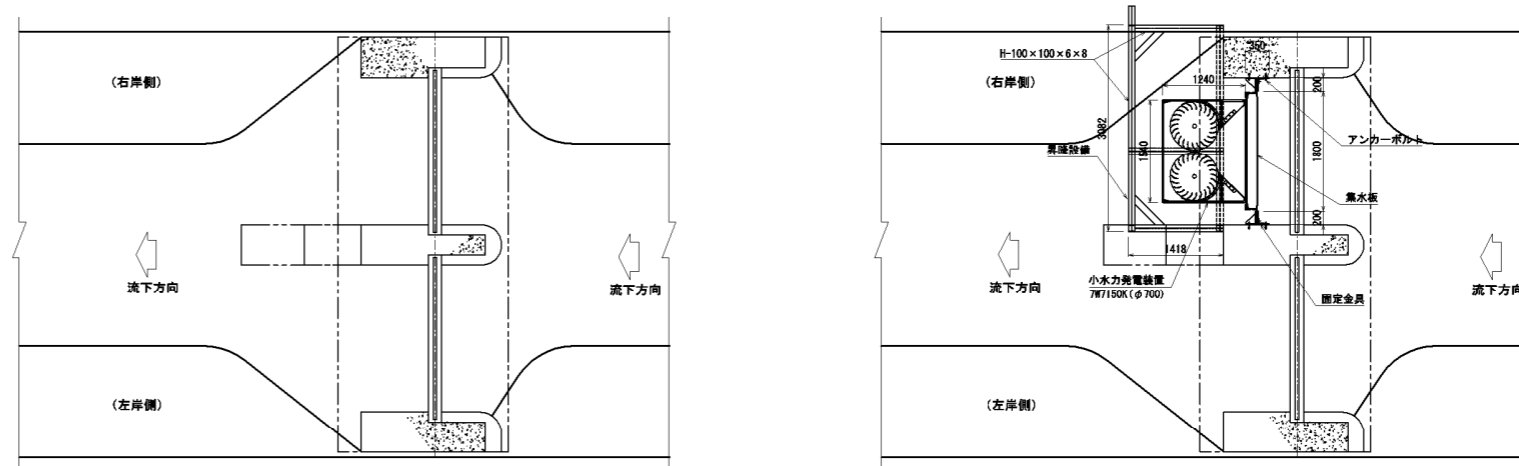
平面配置図 (左: 現状、右: 水車発電設備設置後)
